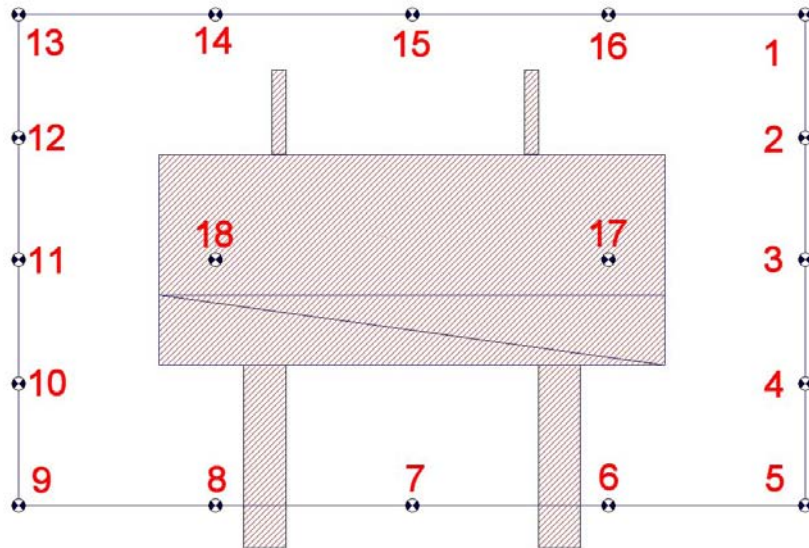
Messpunktachsen 1 bis 18 im Grundriss
